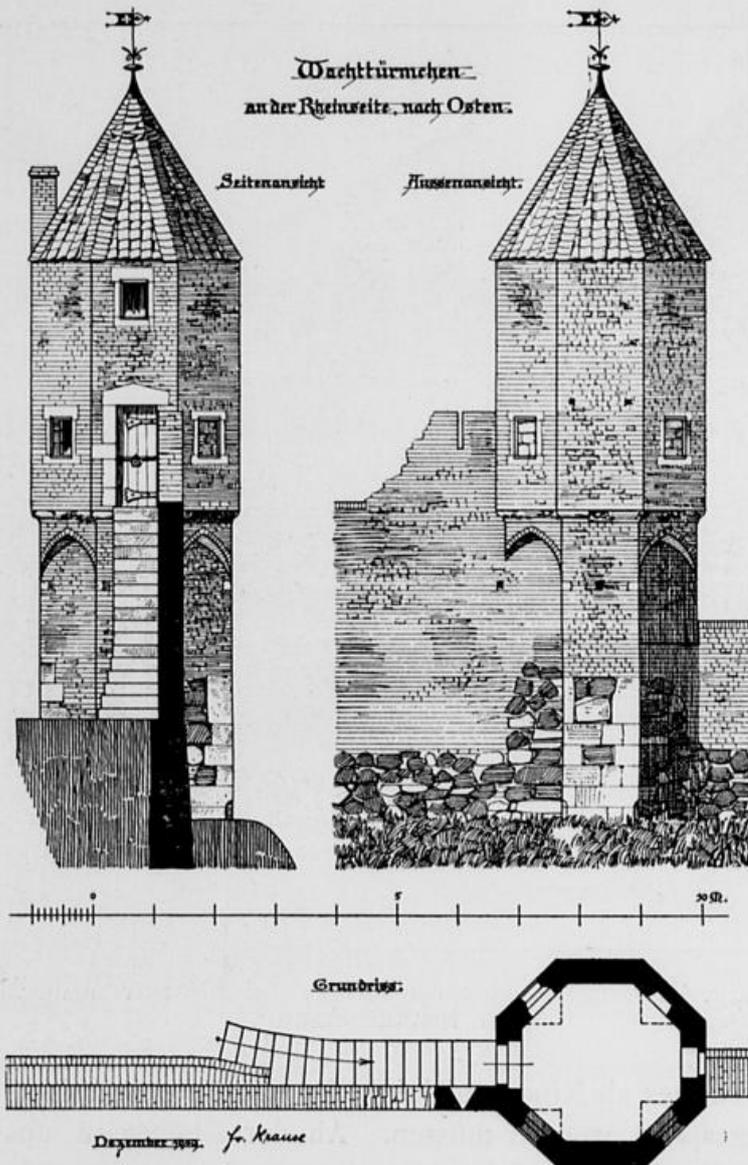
Zons. Grundriss und Aufrisse eines der achteckigen Wachttürmchen der Rheinfront.
